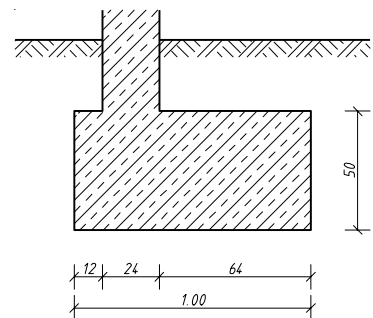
Streifenfundament mit Stahlbetonwand (biegesteifer Anschluß)
